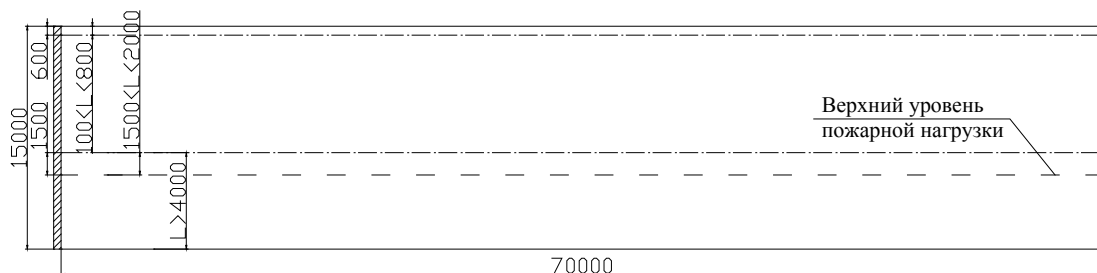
Схема расположения верхнего уровня пожарной нагрузки
